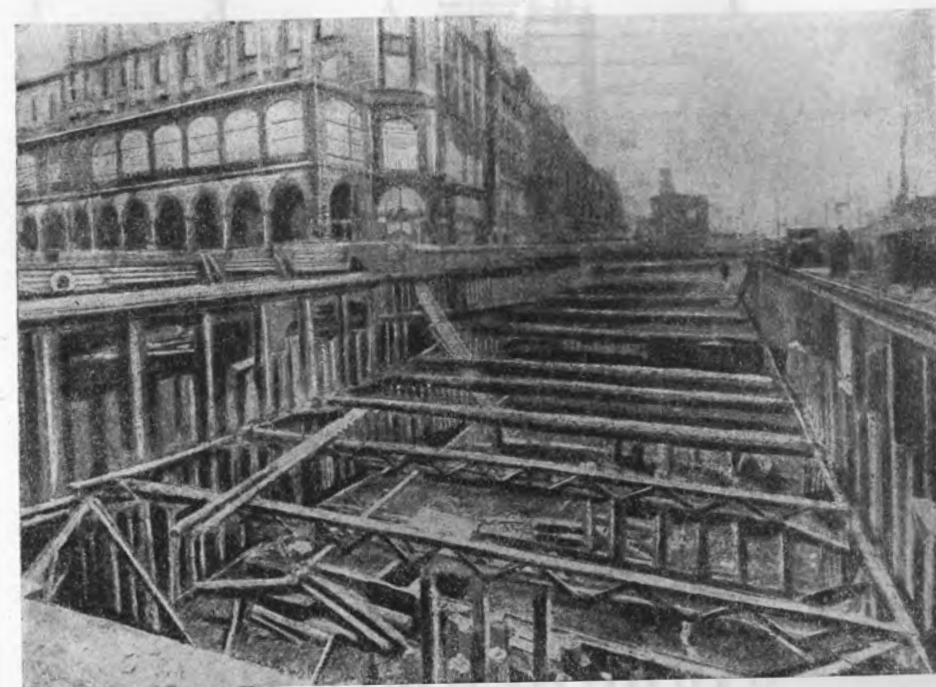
Производство работ в открытом котловане при металлических растрелах.
